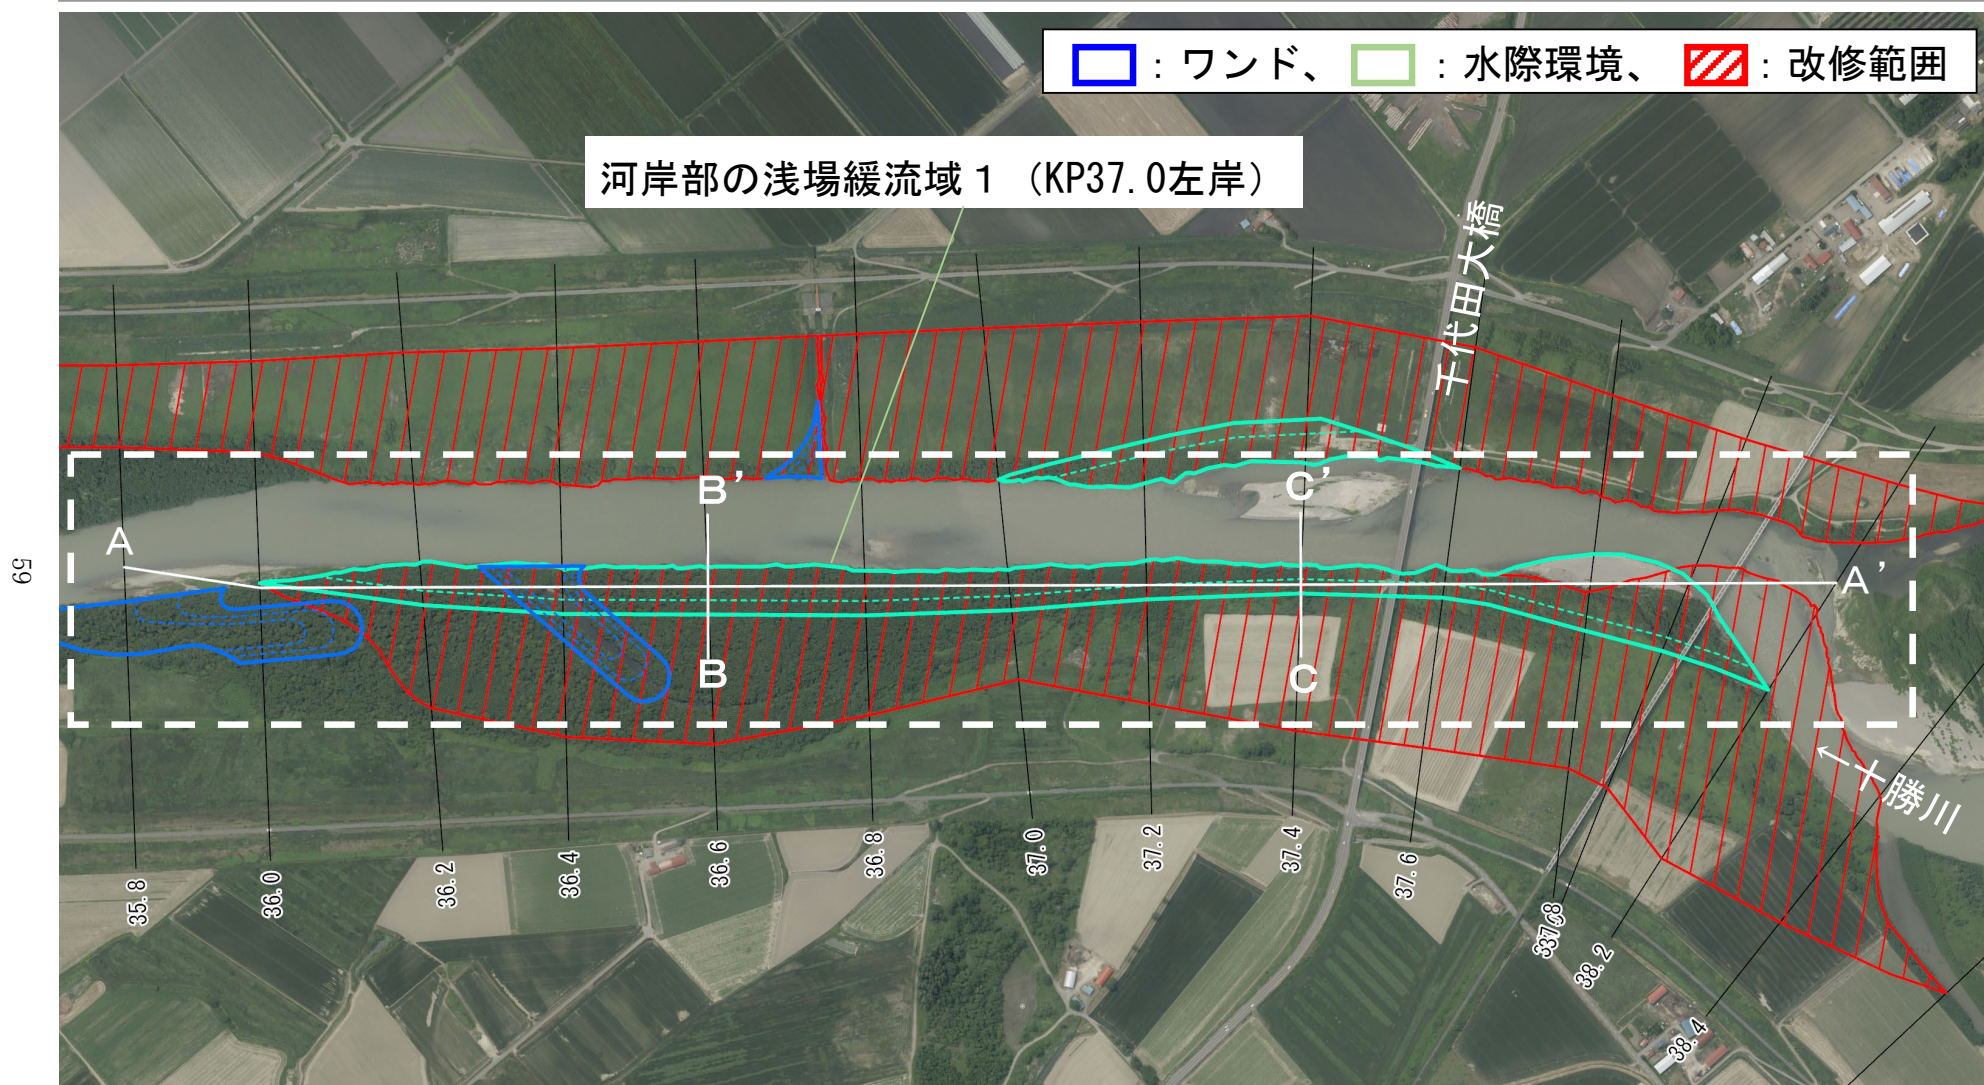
河岸部の浅場緩流域 1 (KP37.0左岸) の平面配置図
